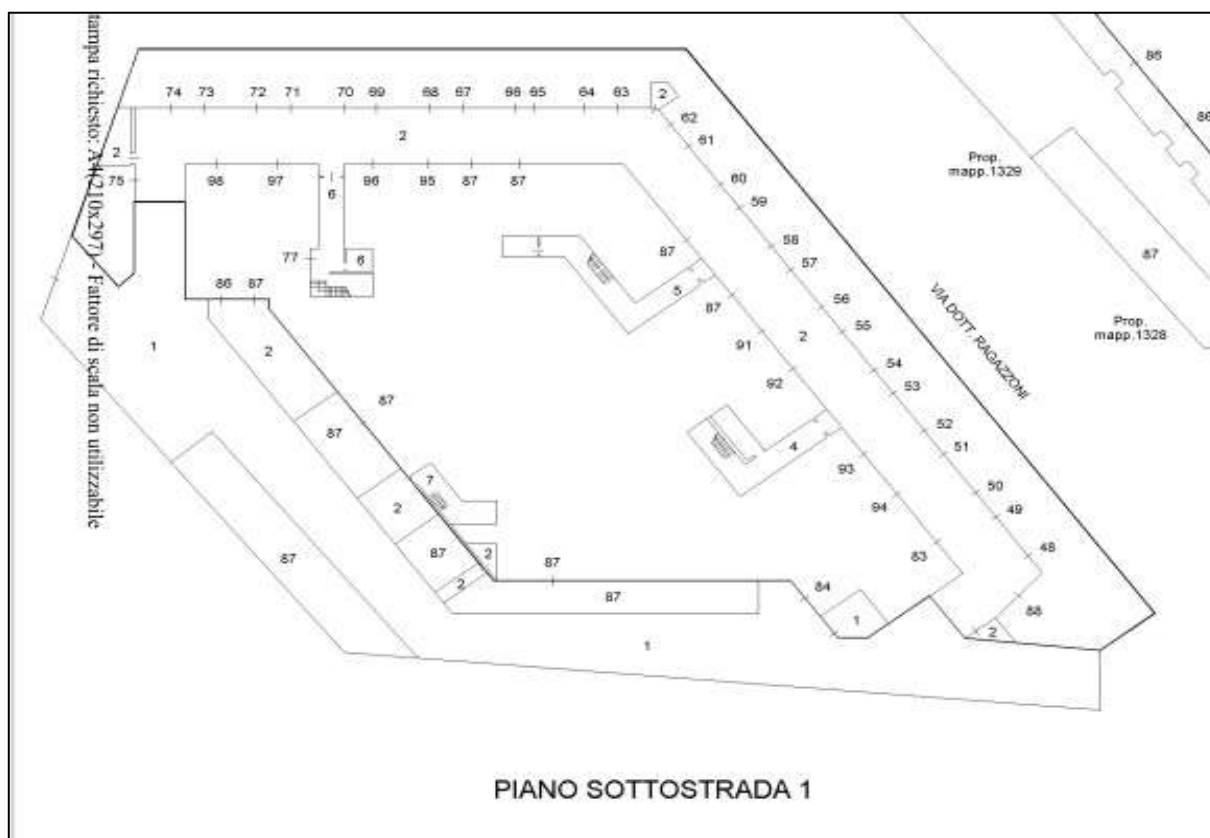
Estratto elaborato planimetrico dei beni (piano S1).
